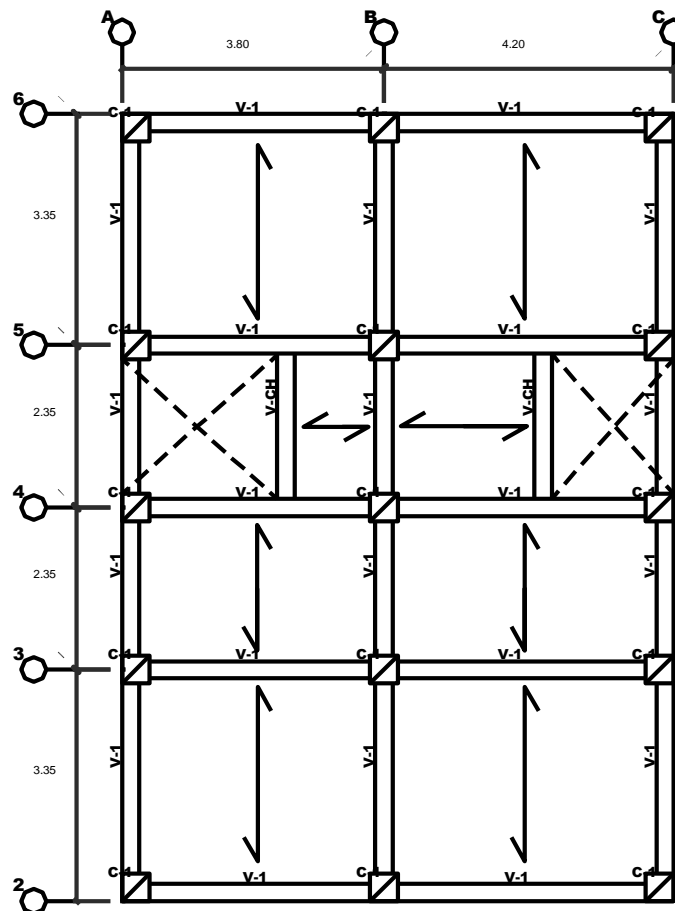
Estructuración del proyecto de vivienda multifamiliar. Elaboración Propia.
